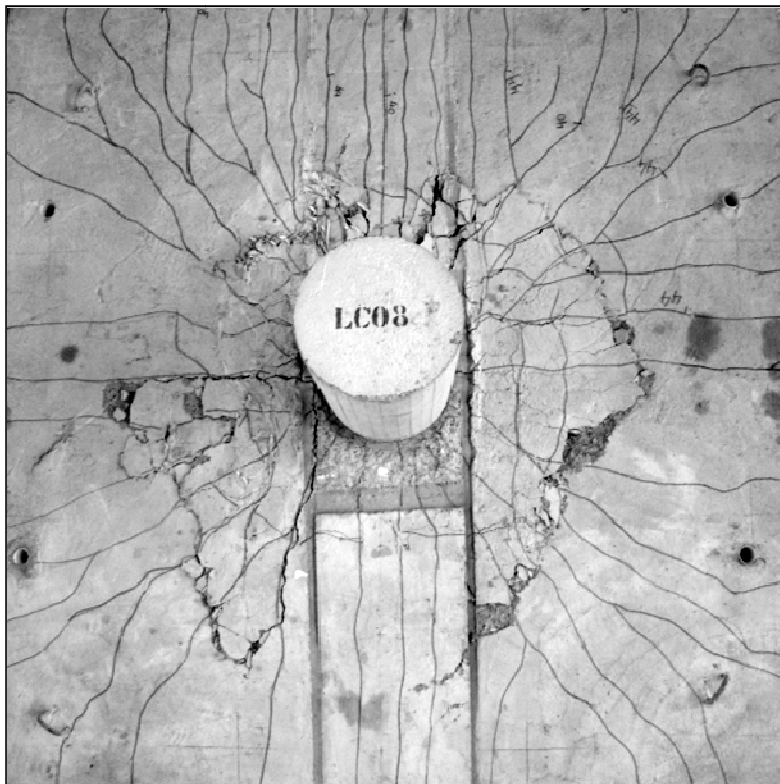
Mapa de fissuração da laje LC08
